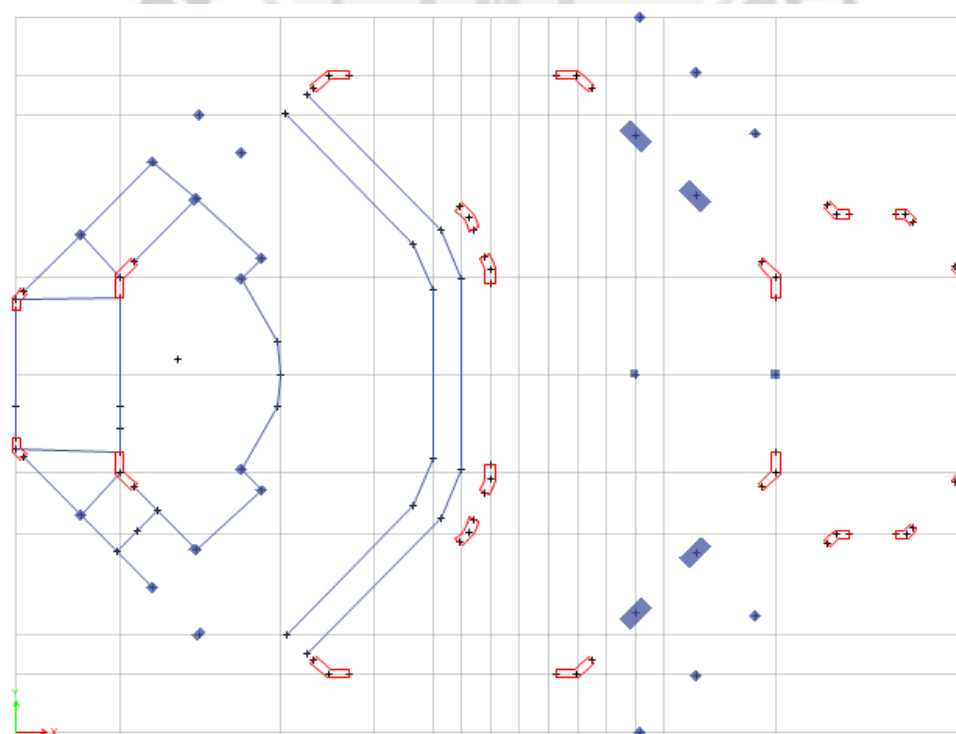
Vista en planta Auditorio – Zona frontal en Escenario
